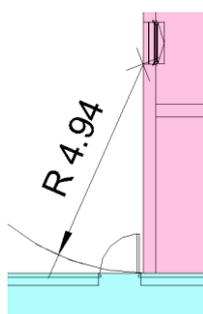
Encuentro entre fachadas alzado oeste del edificio
